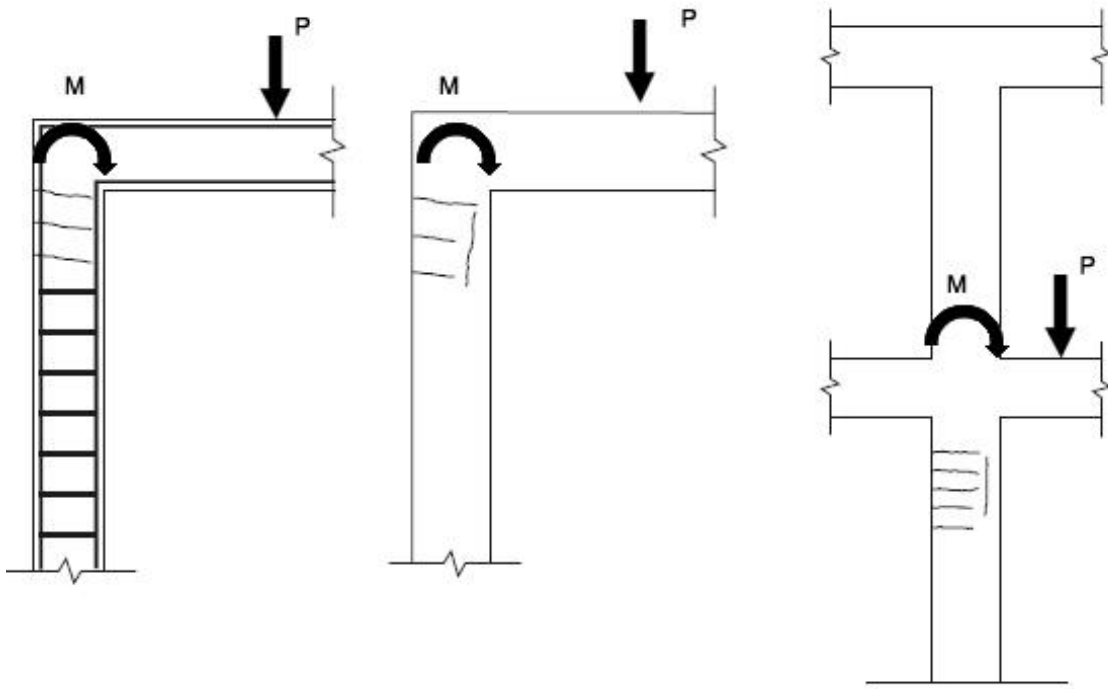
Fissuras causadas por cargas excêntricas
